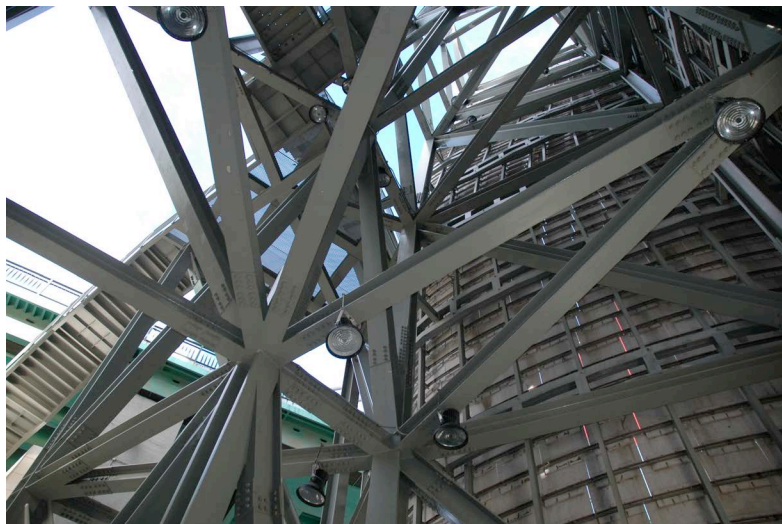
Guggenheim Museum, Turm, Innenansicht
